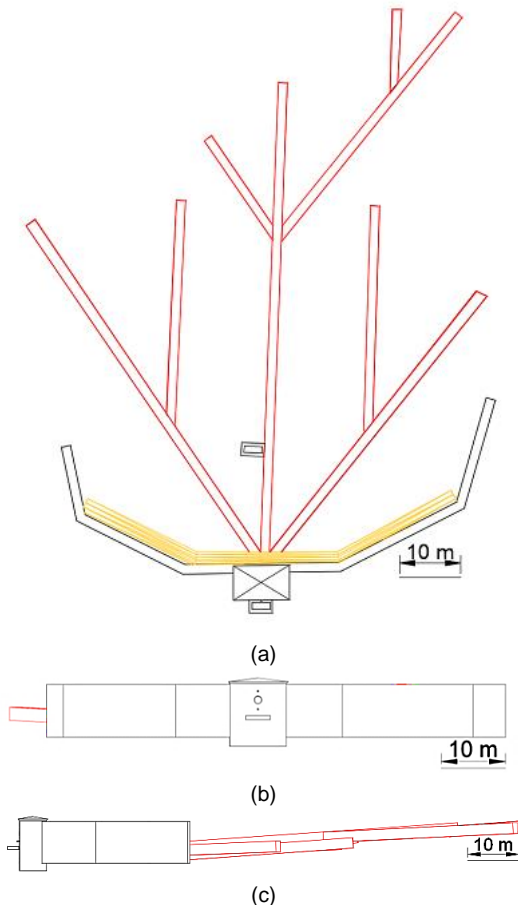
Vistas del sistema de captación diseñado por Sánchez-Molero: a) planta; b) alzado; c) lateral derecha.
